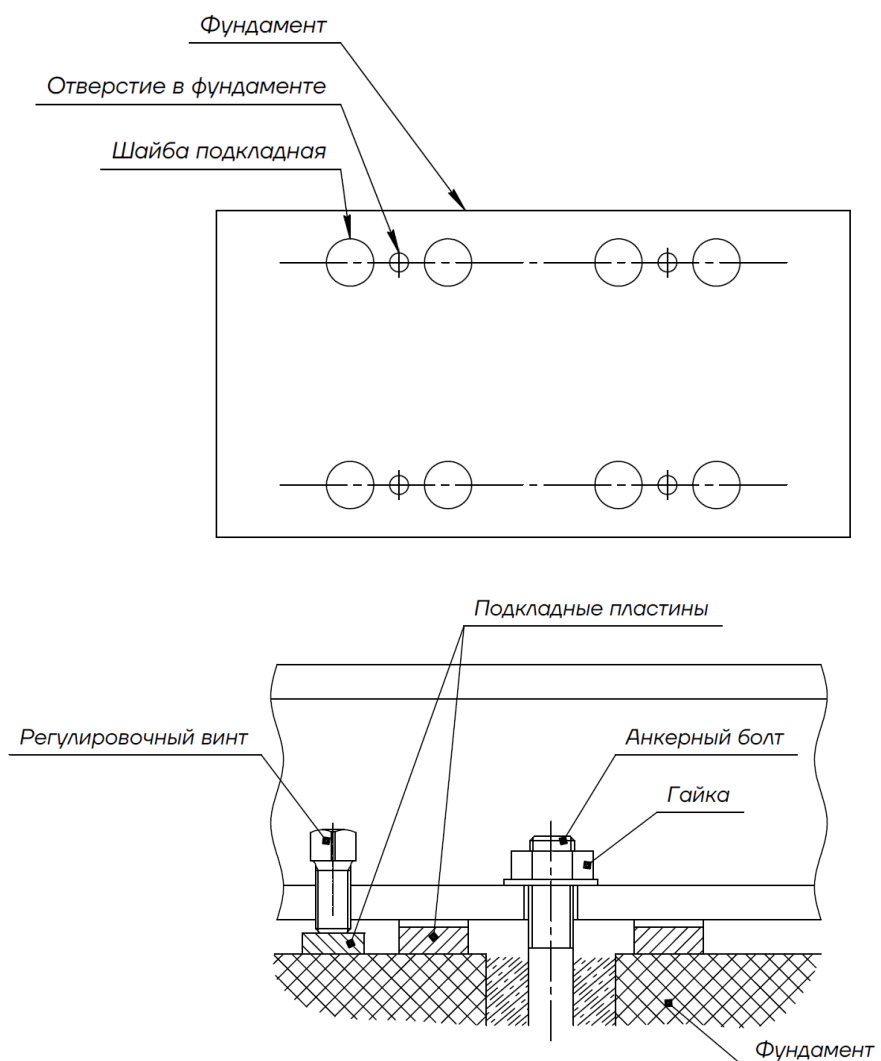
Схема расположения шайб на фундаменте (вид сверху)
